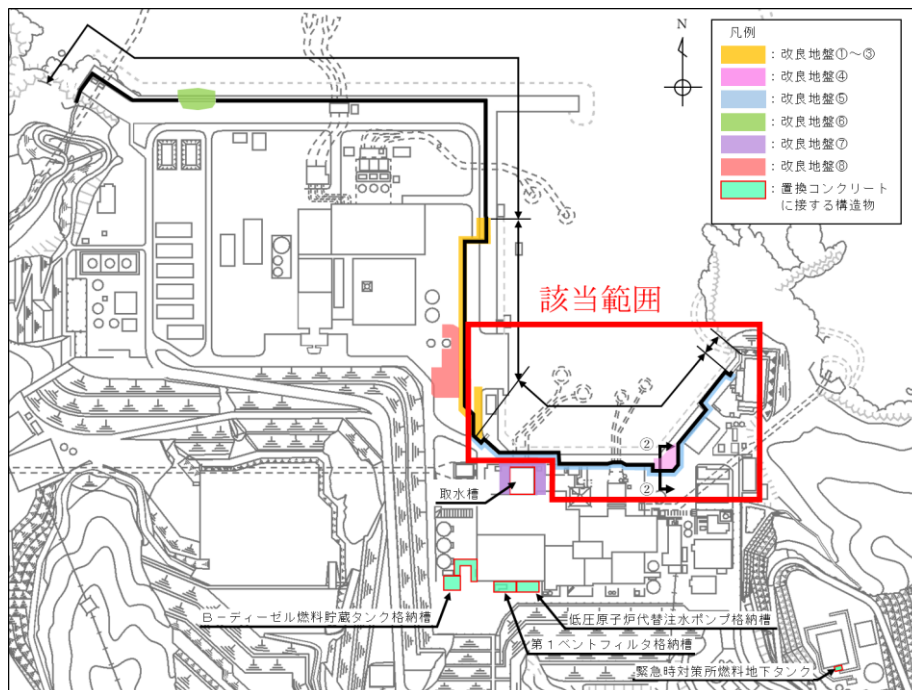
改良地盤④及び改良地盤⑤の平面配置図
